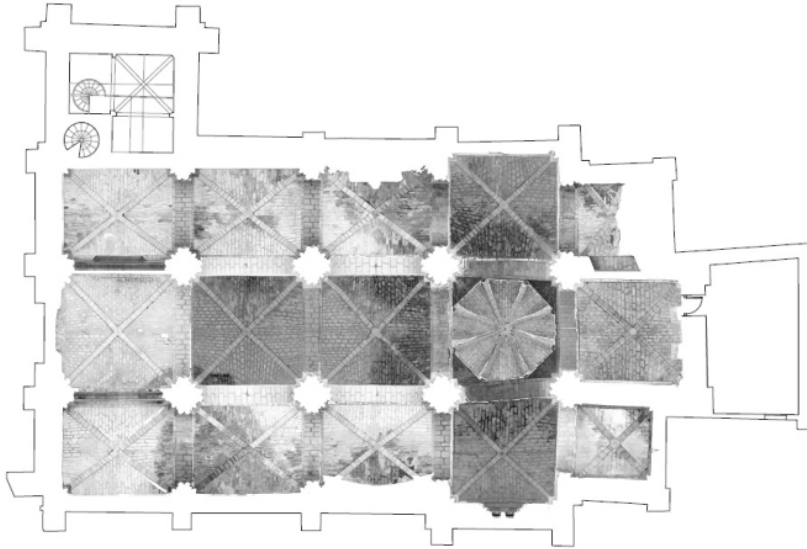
Levantamiento fotogramétrico de las bóvedas de la Iglesia de Santa María la Mayor de Villamuriel de Cerrato (Palencia). Realizado por el Laboratorio de Fotogrametría Arquitectónica de la ETSA de Valladolid.
